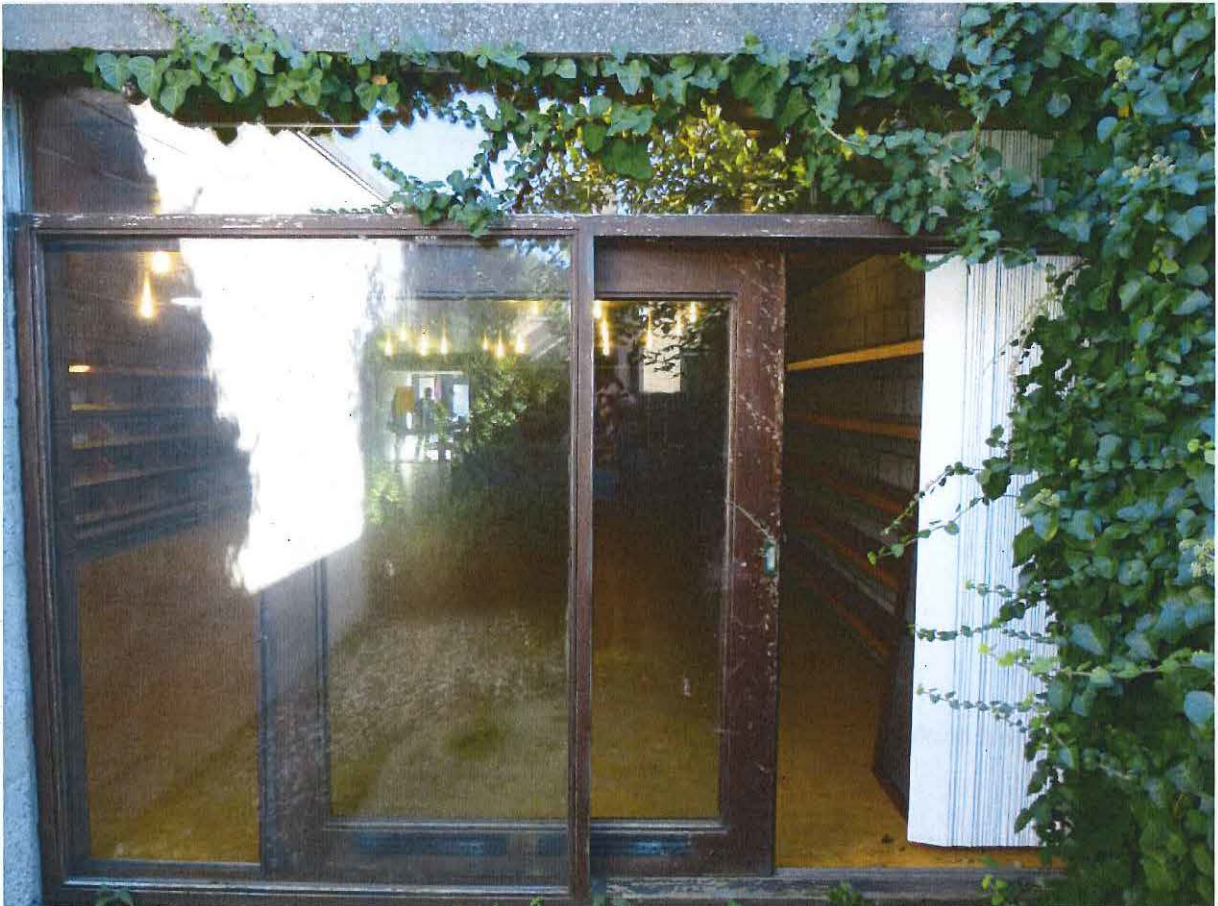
Achtergevel hoofdgebouw, gelijkvloers. Detail van het raam tussen bibliotheek en binnentuin.
